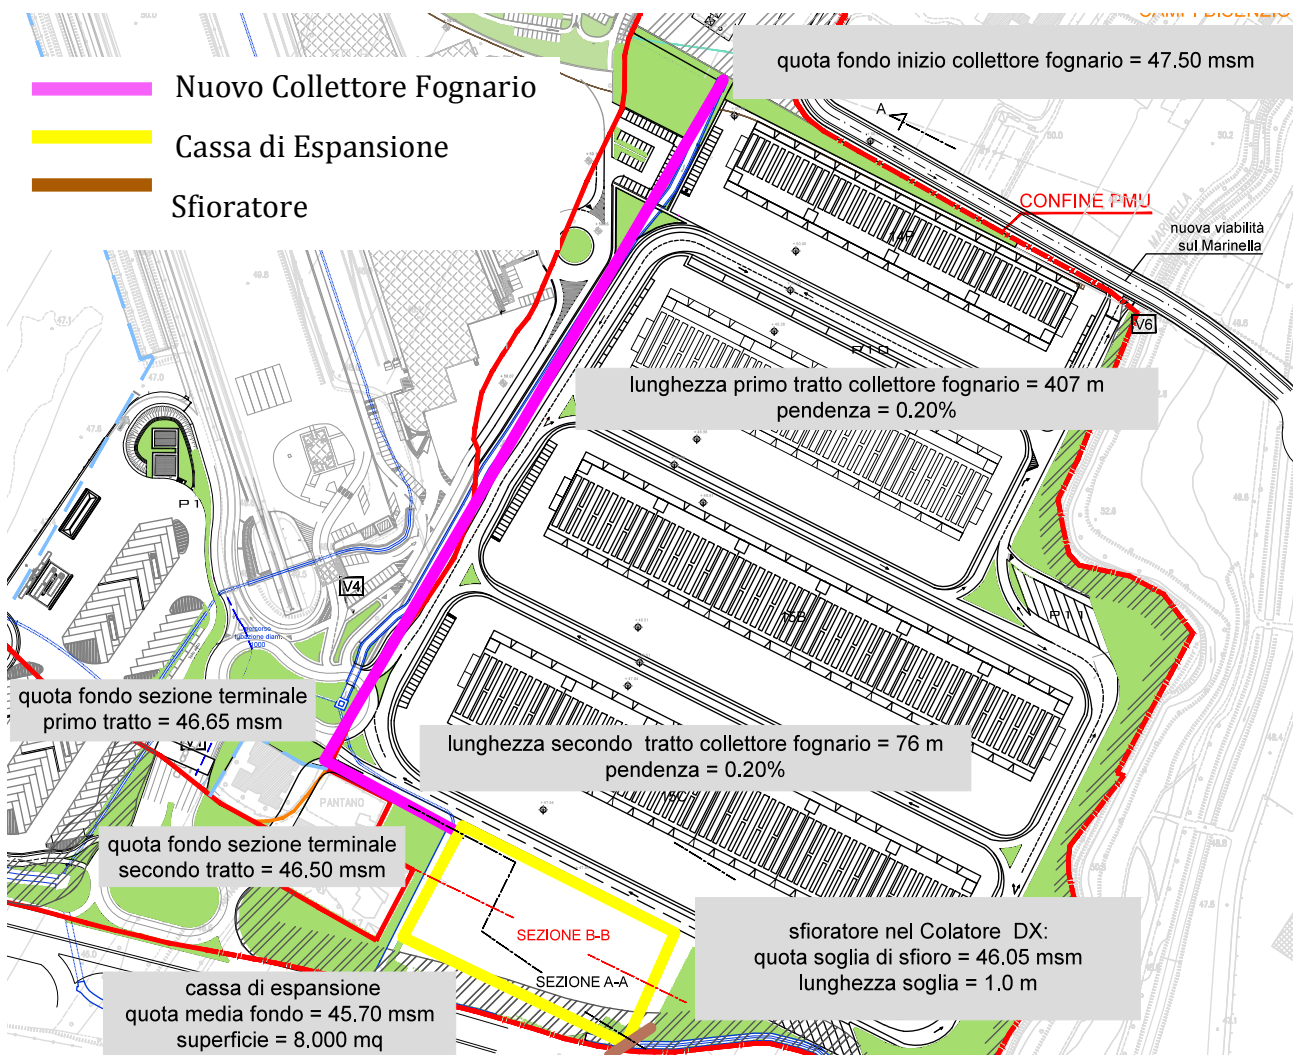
Planimetria dell'area di ampliamento con indicazione delle nuove opere idrauliche (collettore fognario, cassa di espansione, sfioratore).
